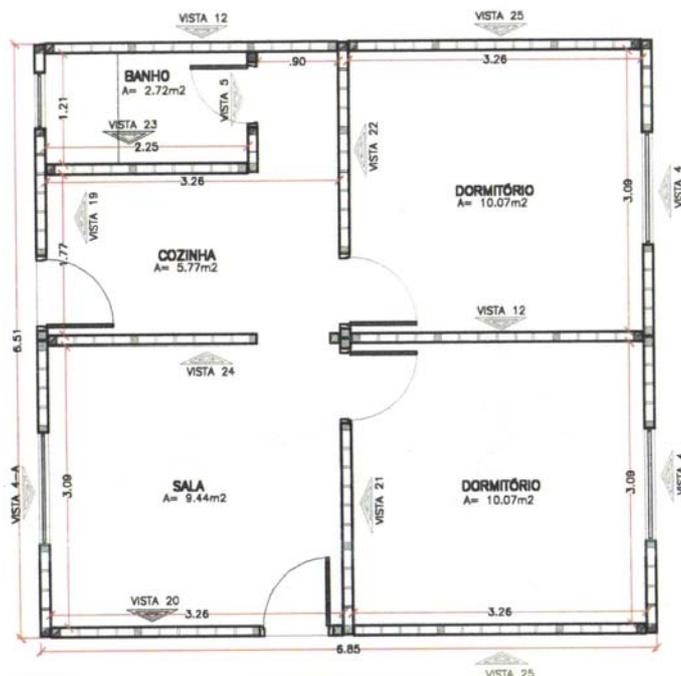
Projeto da edificação utilizada nos ensaios de desempenho estrutural
